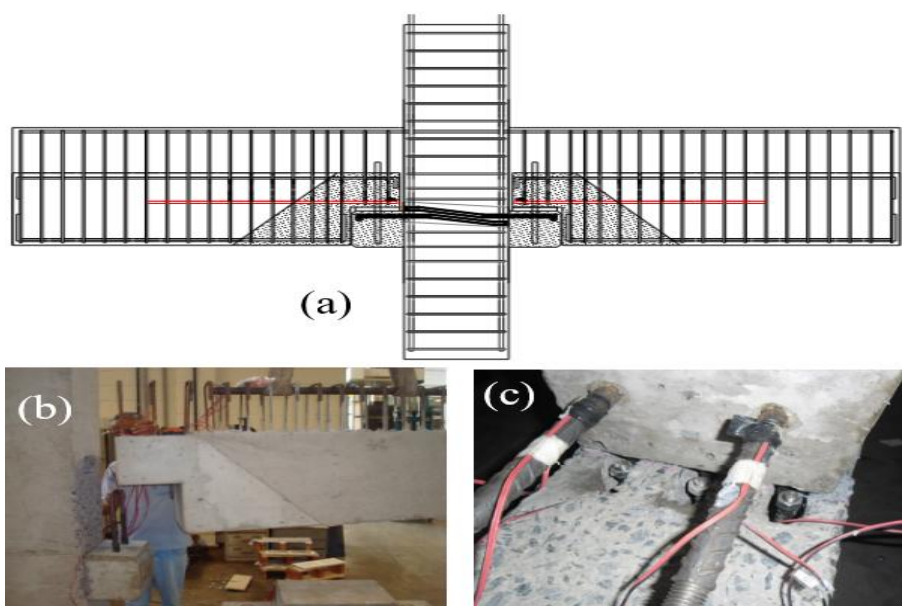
Ligação viga-pilar com chumbadores inclinados: a) Esquema em elevação; b) Seção transversal na região da ligação
